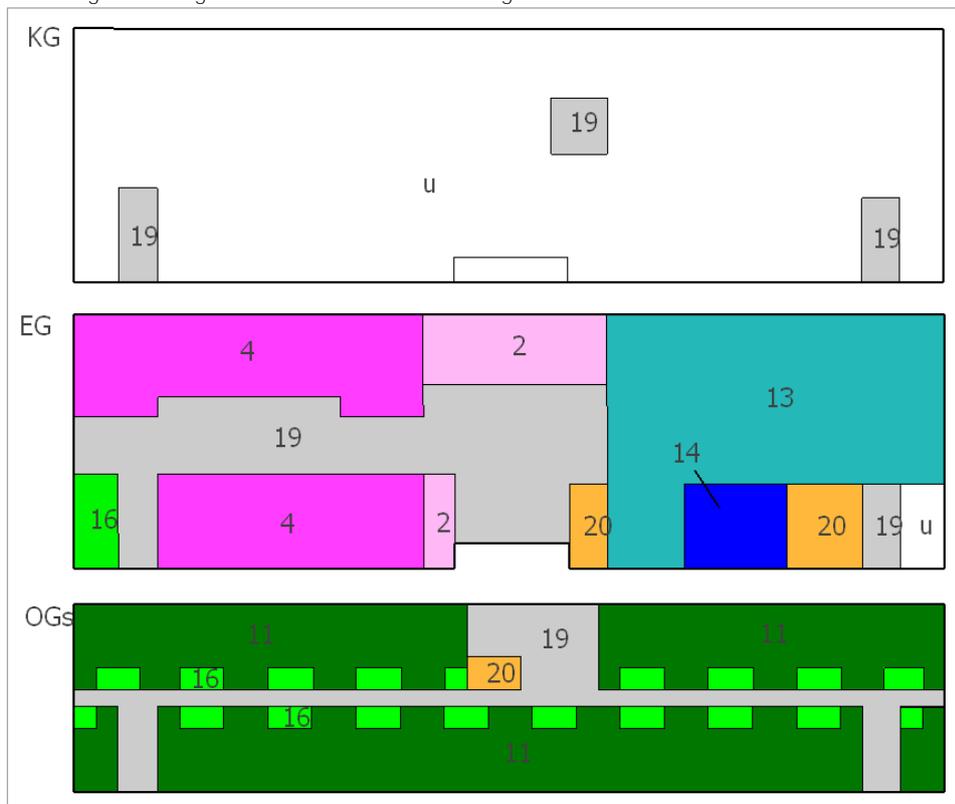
Hotelgebäude: Grundrisse mit Zonierung
